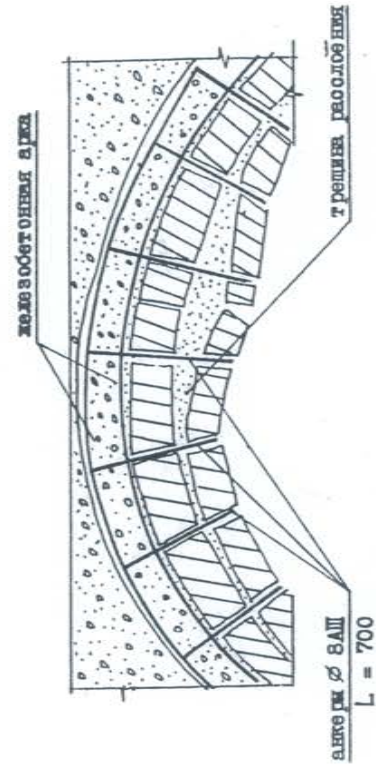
Укрепление деформированных оводов дублирующими арочными элементами
